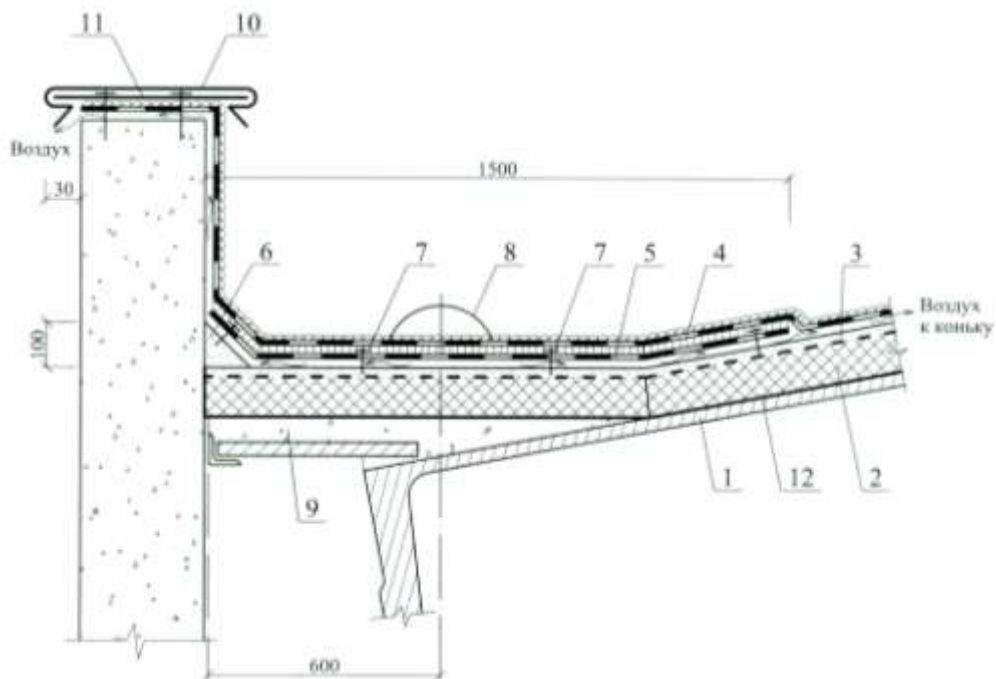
Примыкание водоизоляционного слоя к парапету
